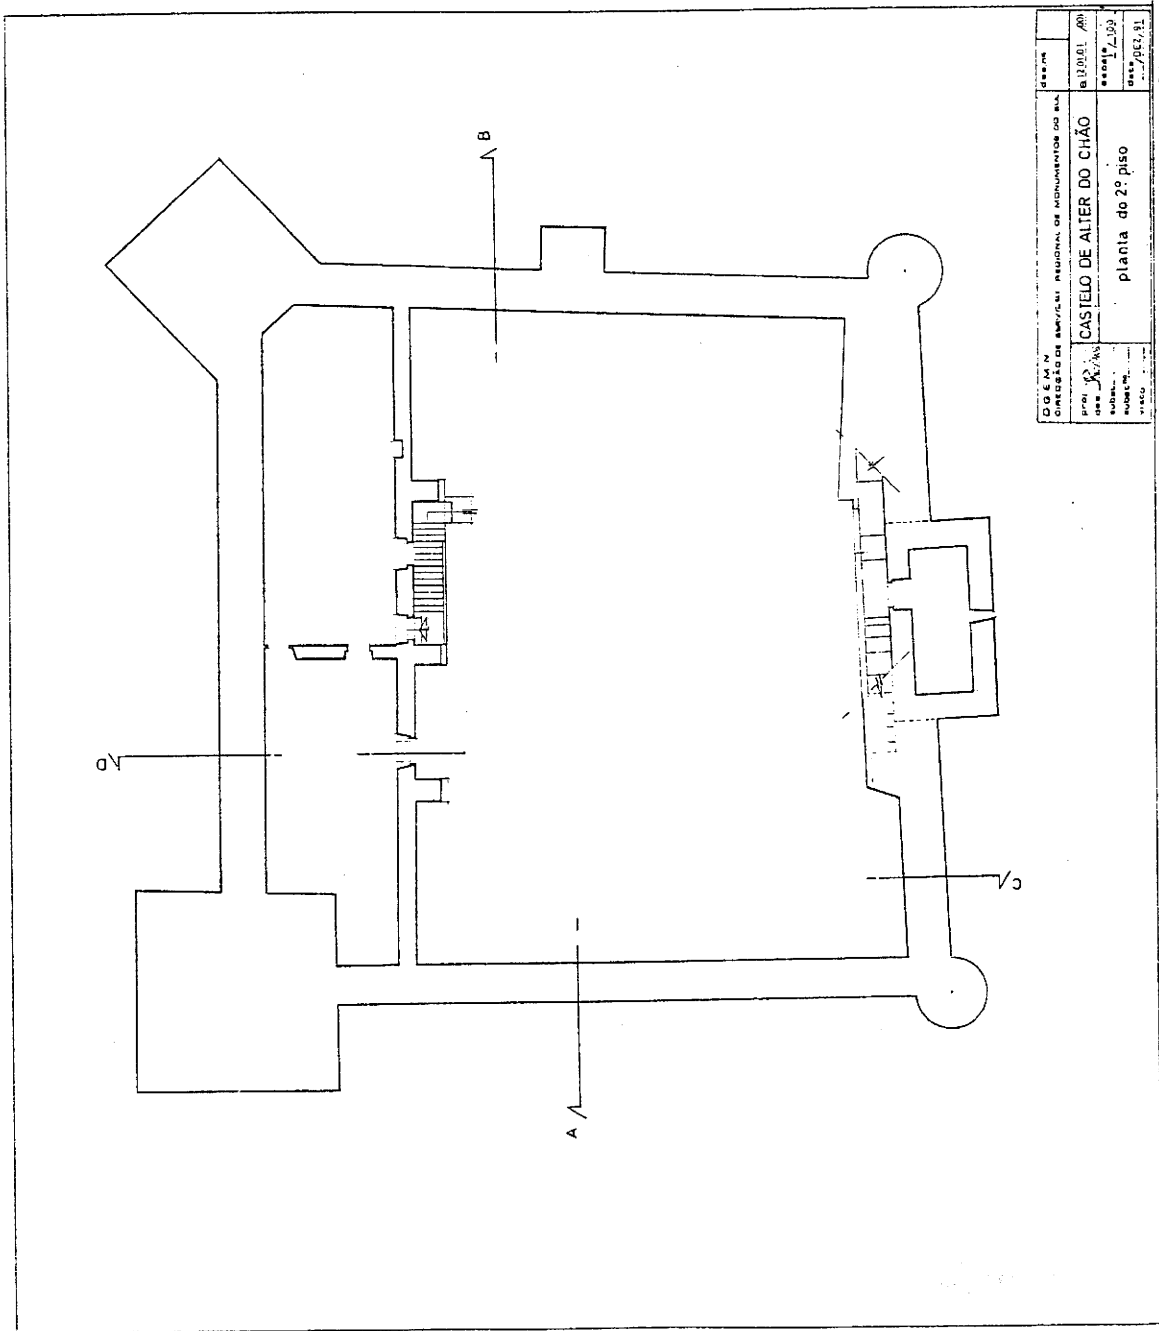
Castelo de Alter do Chão. Planta do 2º piso
